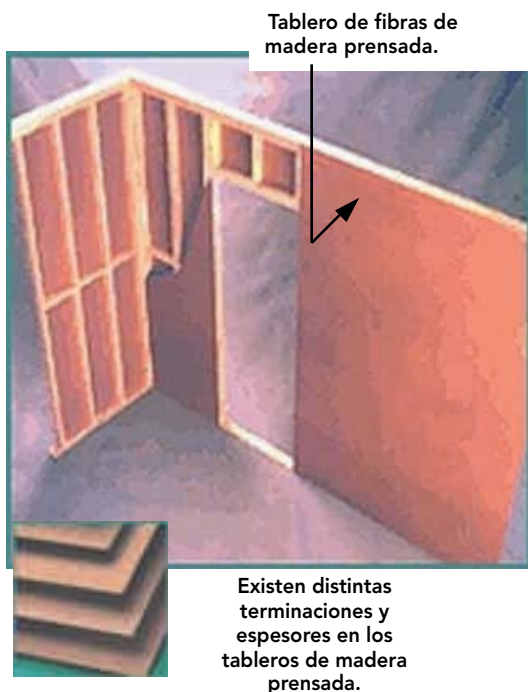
24: Revestimiento con paneles de madera prensada.
